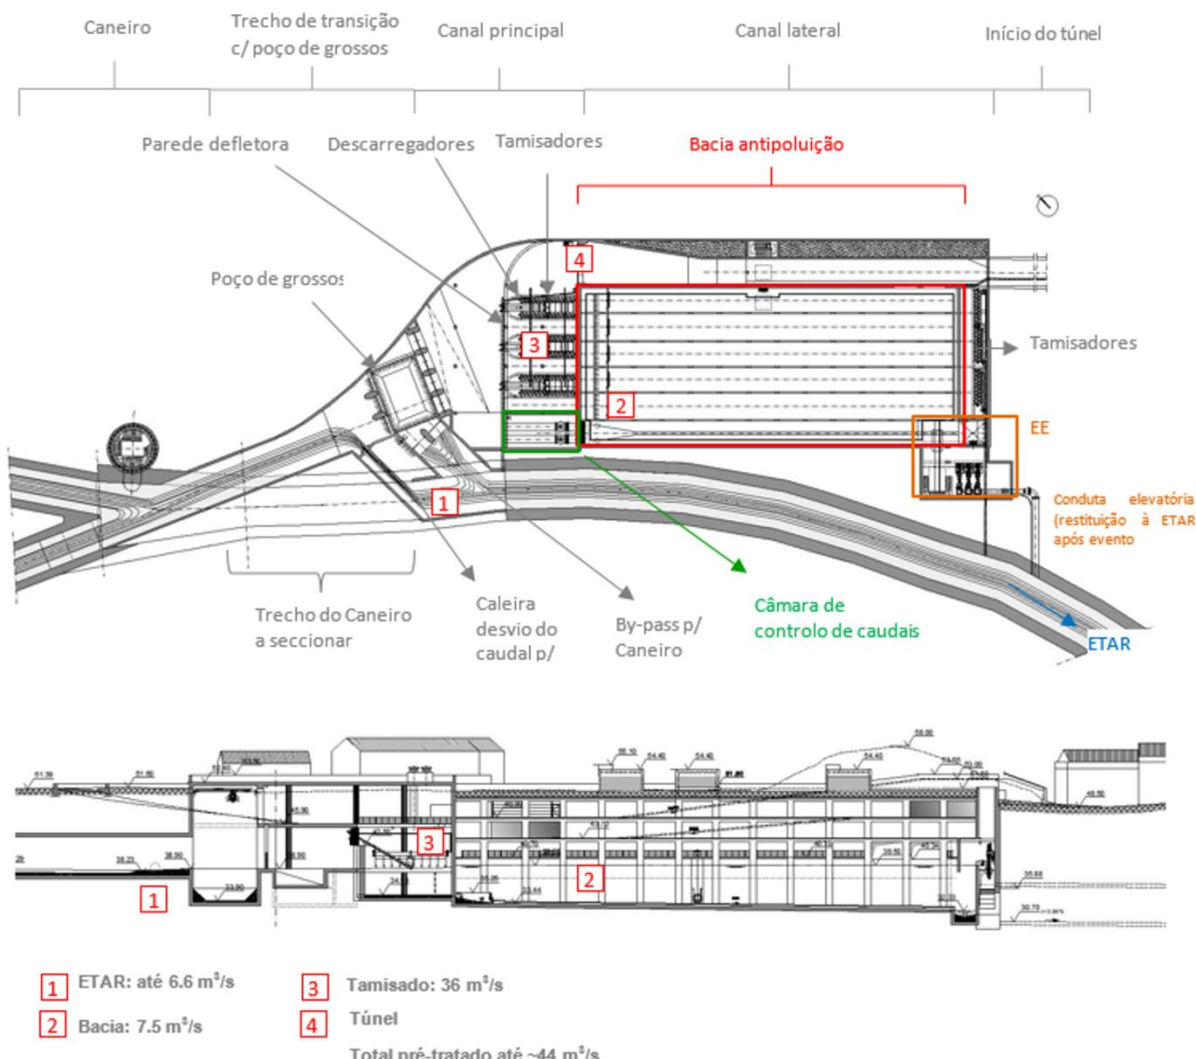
Representação esquemática, em planta e corte, do piso inferior da obra de desvio do Caneiro de Alcântara
